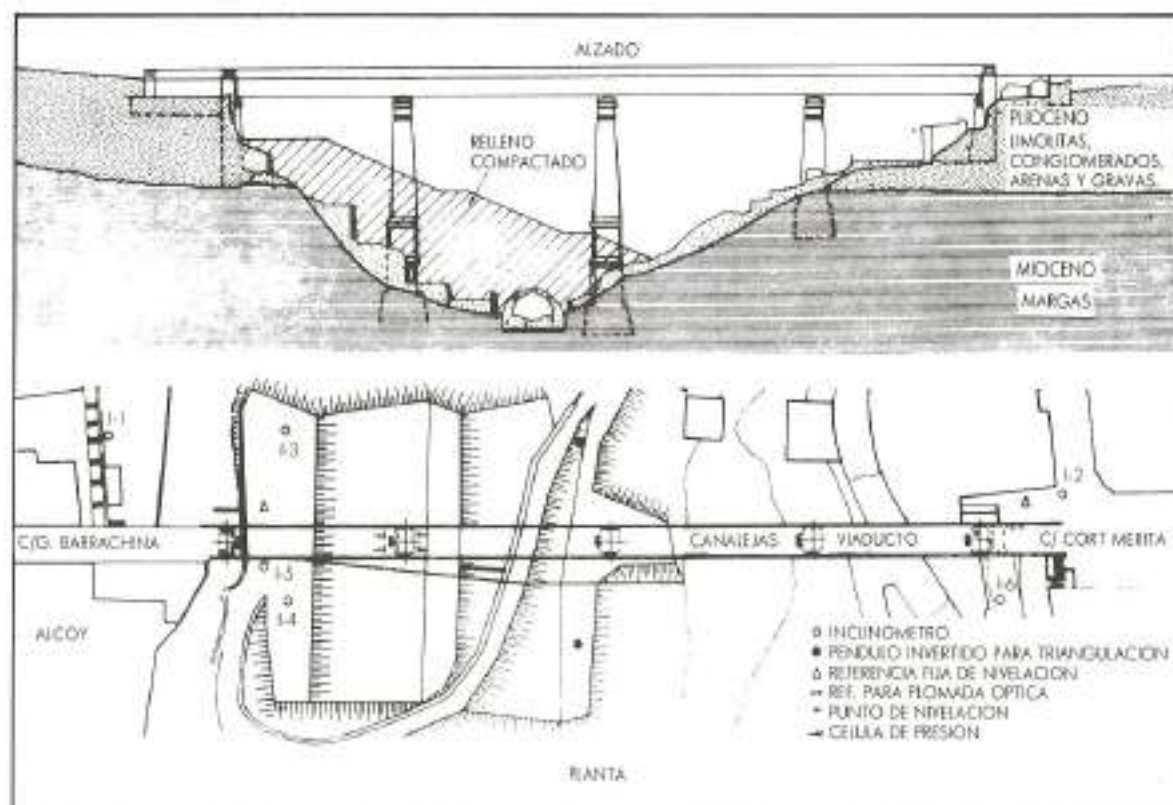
Planta y alzado del Viaducto de Canalejas, con descripción general del terreno y disposición de la instrumentación.
